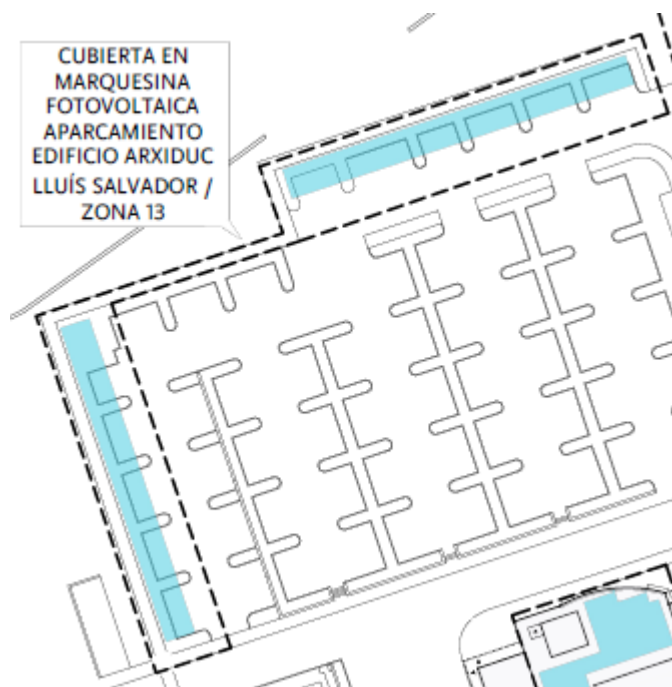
Disposición de las placas fotovoltaicas en cubierta en marquesina de aparcamiento del edificio Arxiduc Lluís Salvador
